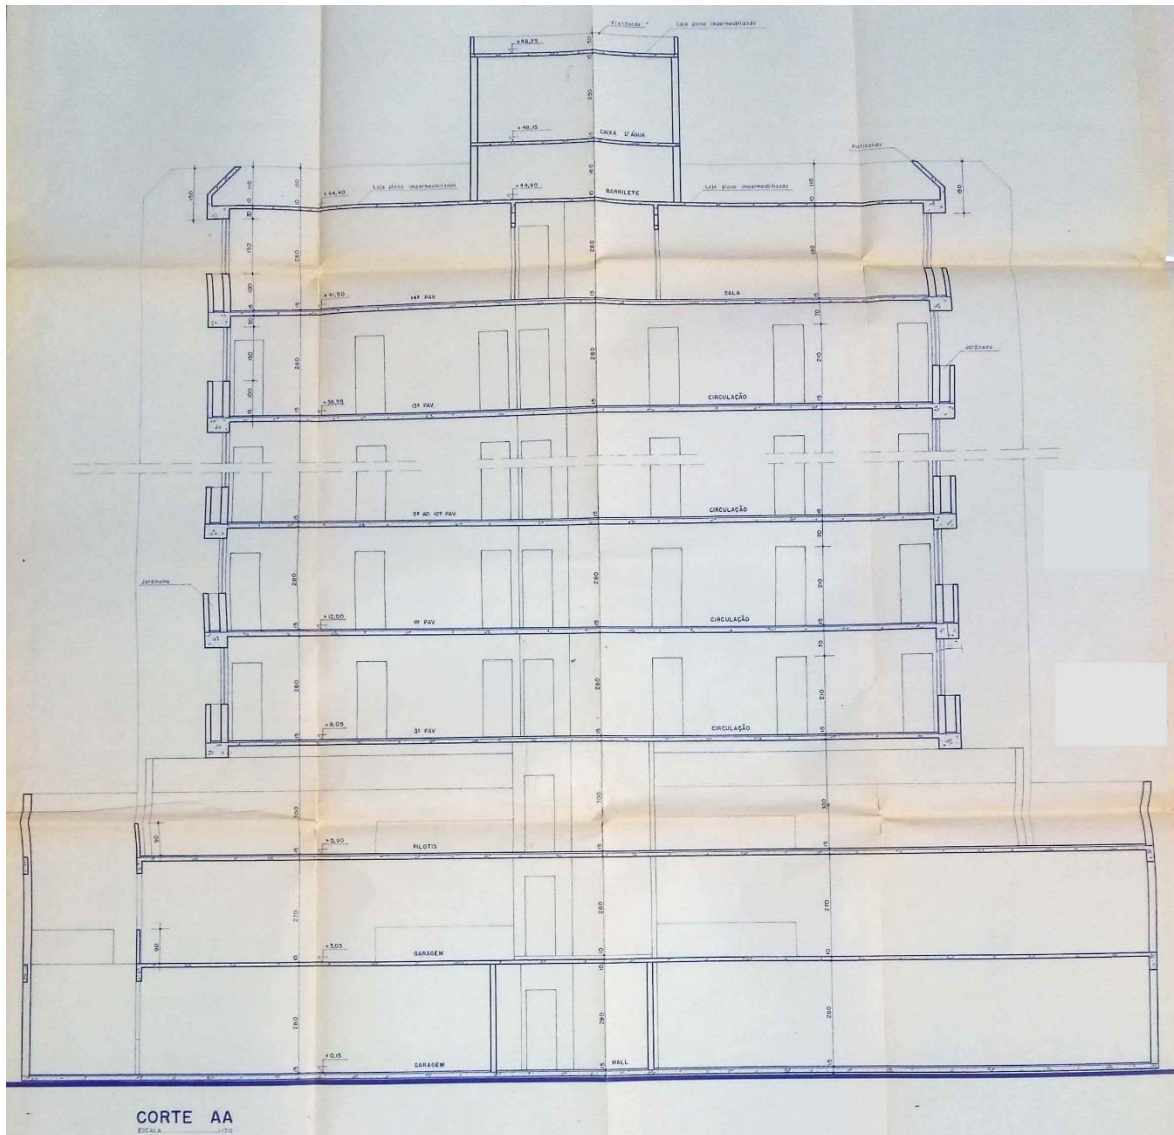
Corte Longitudinal do projeto arquitetônico.
